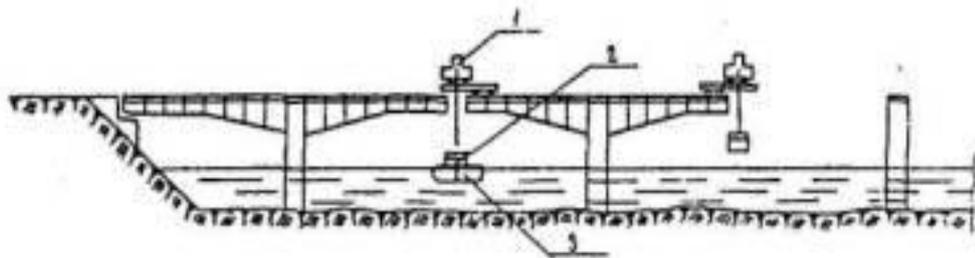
Схема навесной уравновешенной сборки: 1-монтажный кран; 2-блок; 3-понтон или другое транспортное средство [77]
